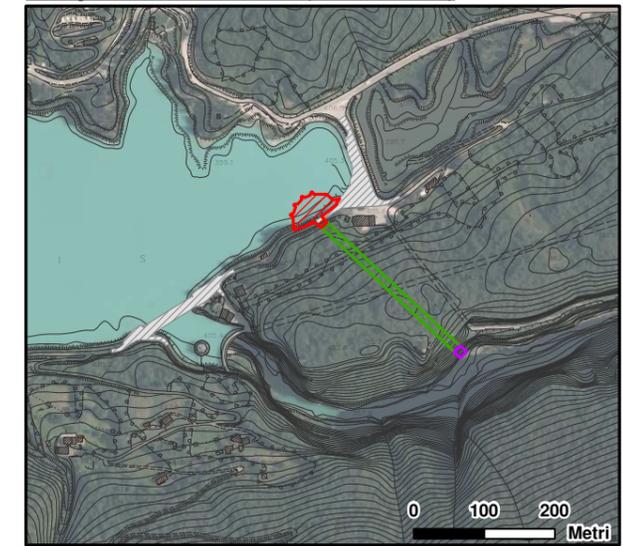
Planimetria delle opere in progetto (Scala 1:1.000)
